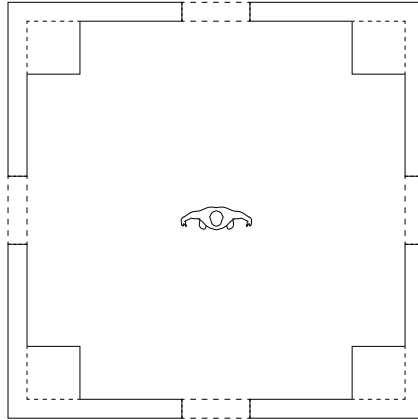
Pos. I.IV* | *Grundriss – M.1:100
